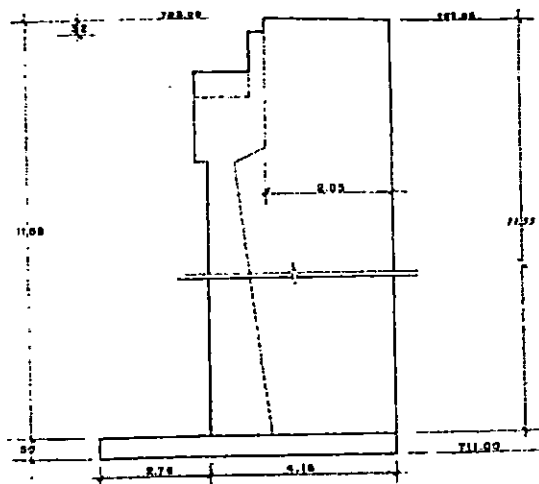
ELEVACION ALA ESTRIBO
